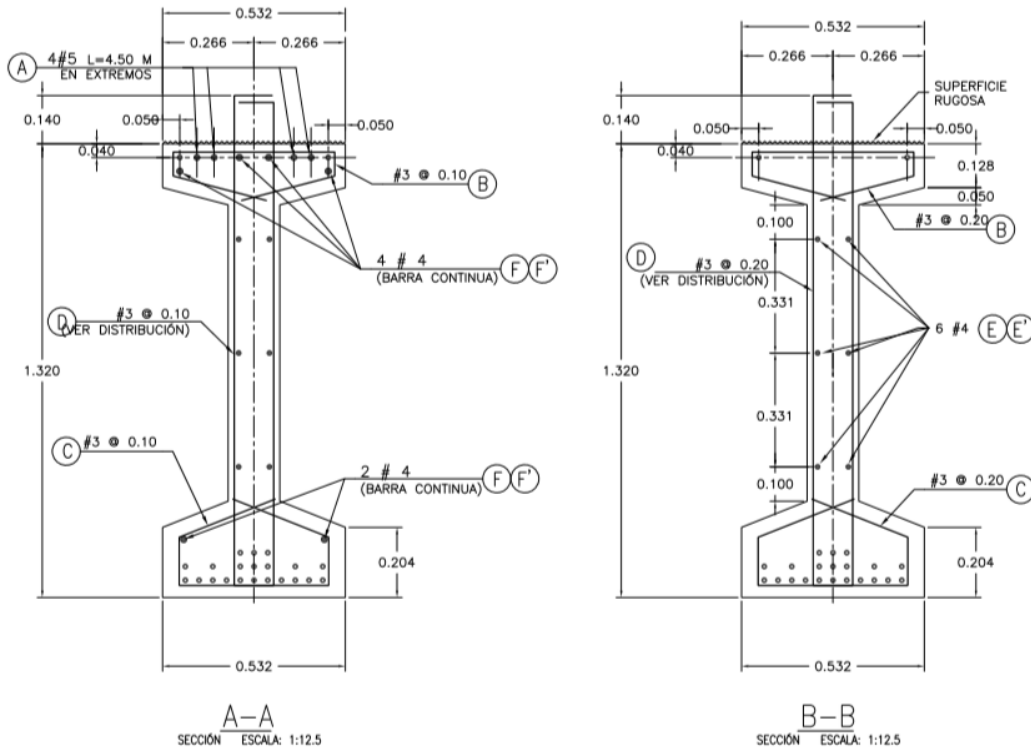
Detalles de Armado de Viga WS-80, Claro= 20 mts
